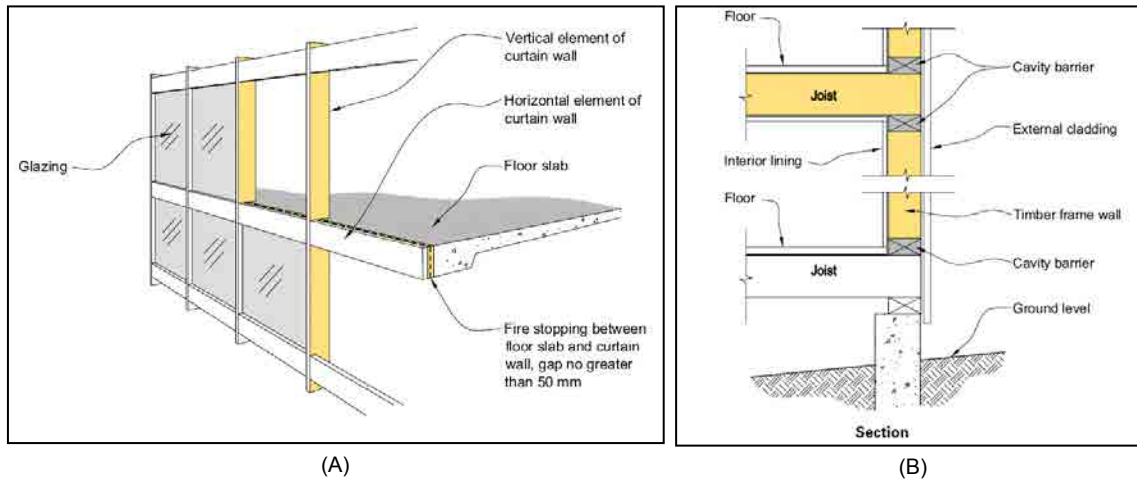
Disposiciones para la protección de las fachadas ligeras. (A) Sellos en muros en la cavidad perimetral del encuentro forjado – muro cortina (B) Barreras en fachadas con cámara.
